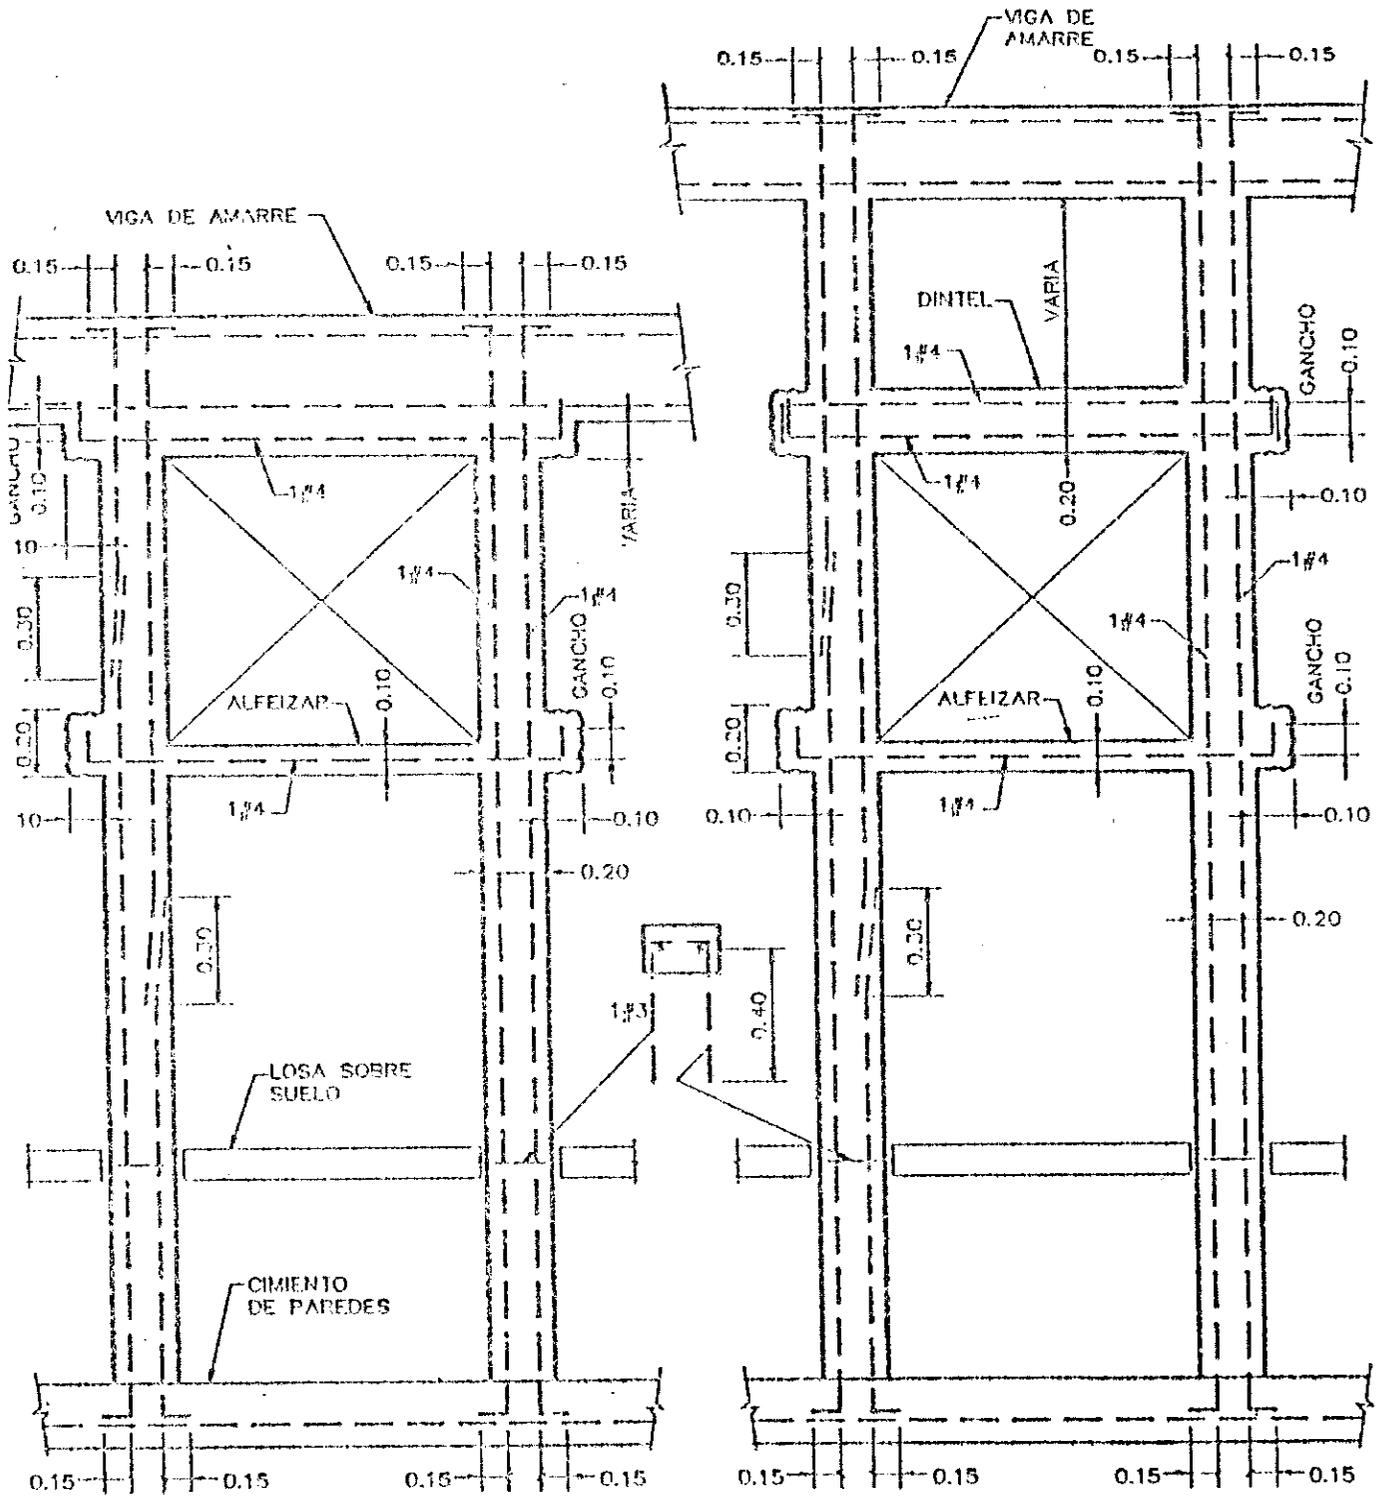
REFUERZO ALREDEDOR DE VENTANAS
